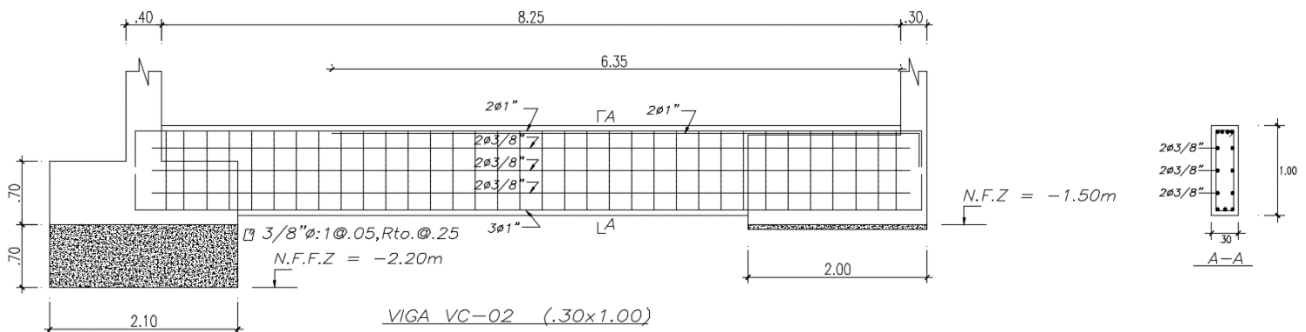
Viga de cimentación VC-02 (.30 x 1.00)
